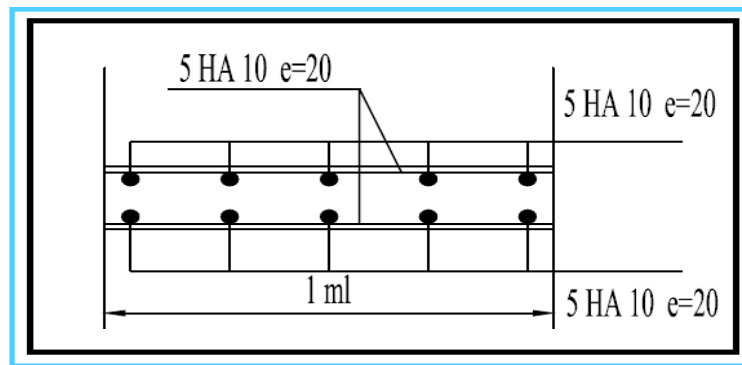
Schéma de ferrailage de la dalle La dalle de l'ascenseur.
